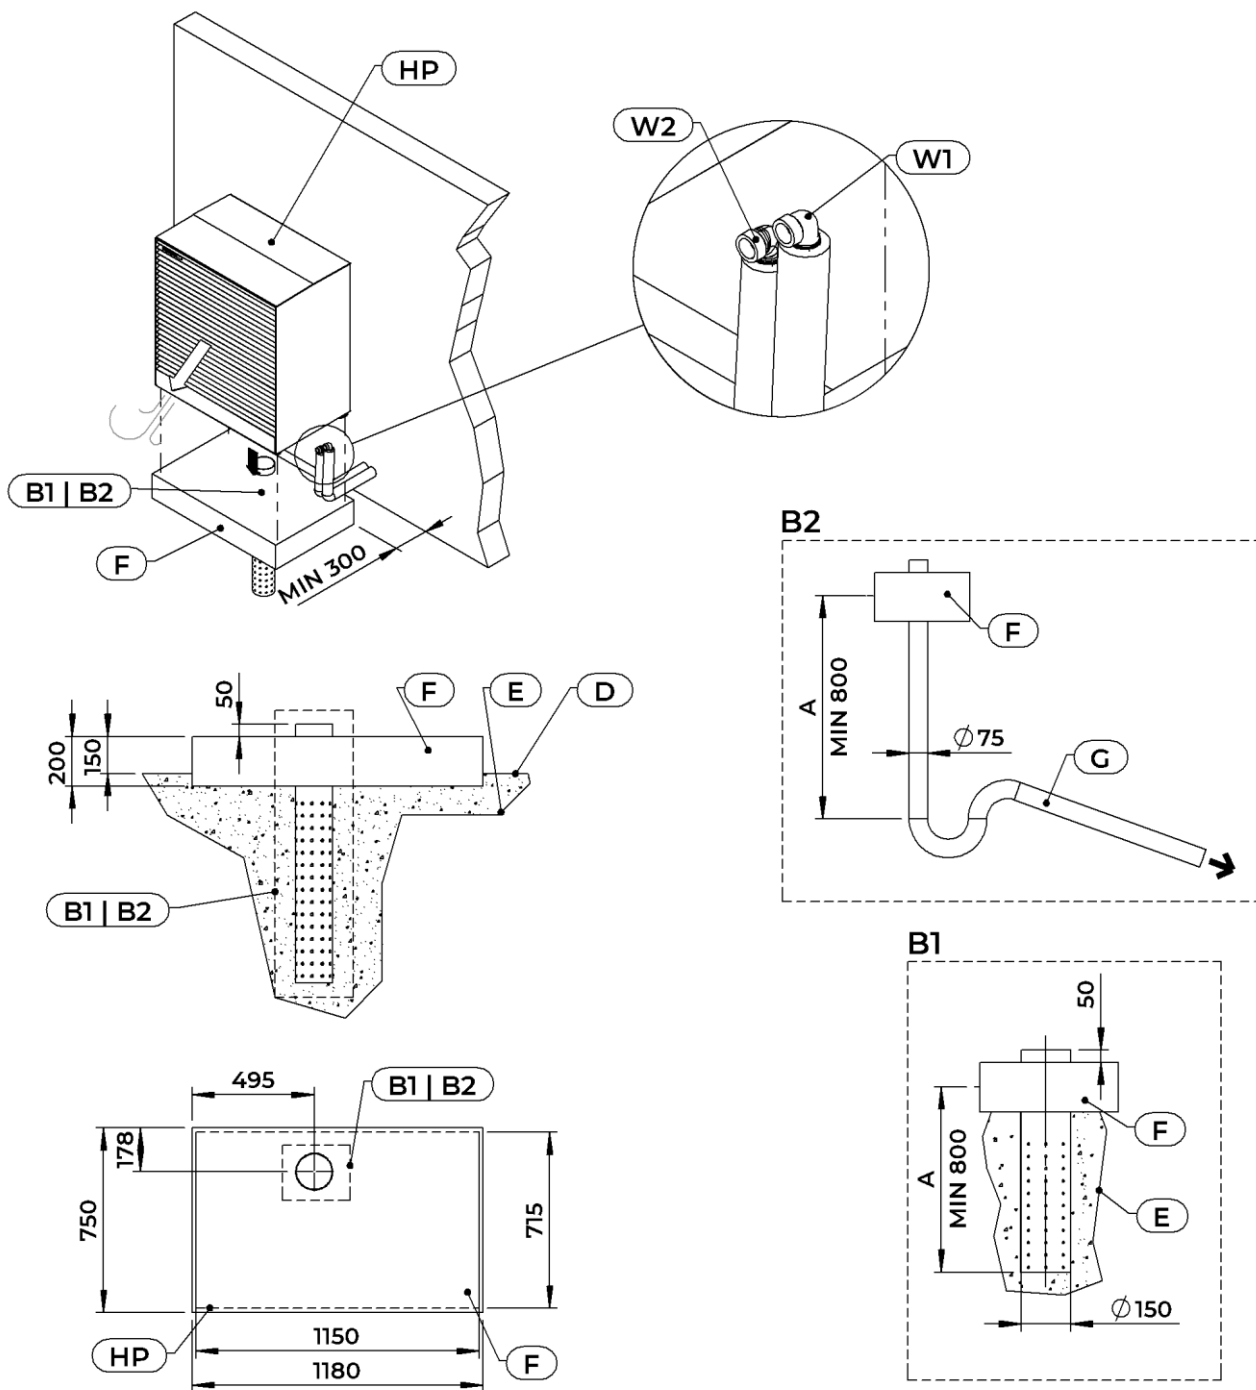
Betonfundament ADAPT 2, Rohranschluss oberirdisch
